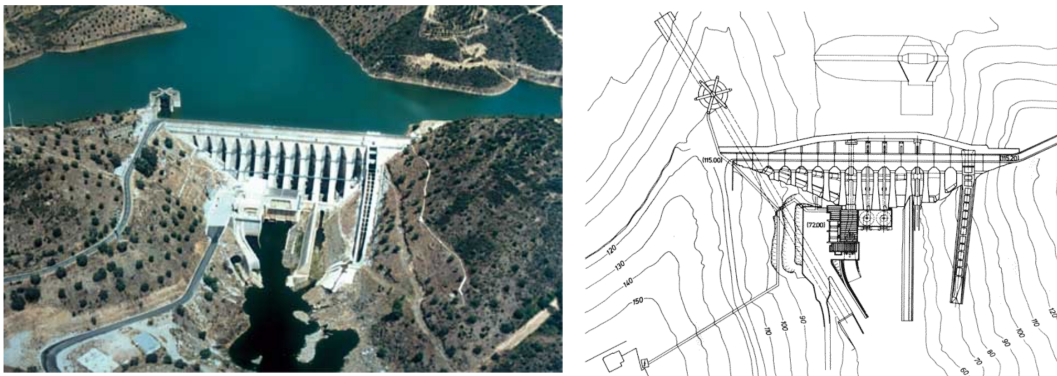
Barragem de Pracana. Planta. (cnpqb.apambiente.pt).
